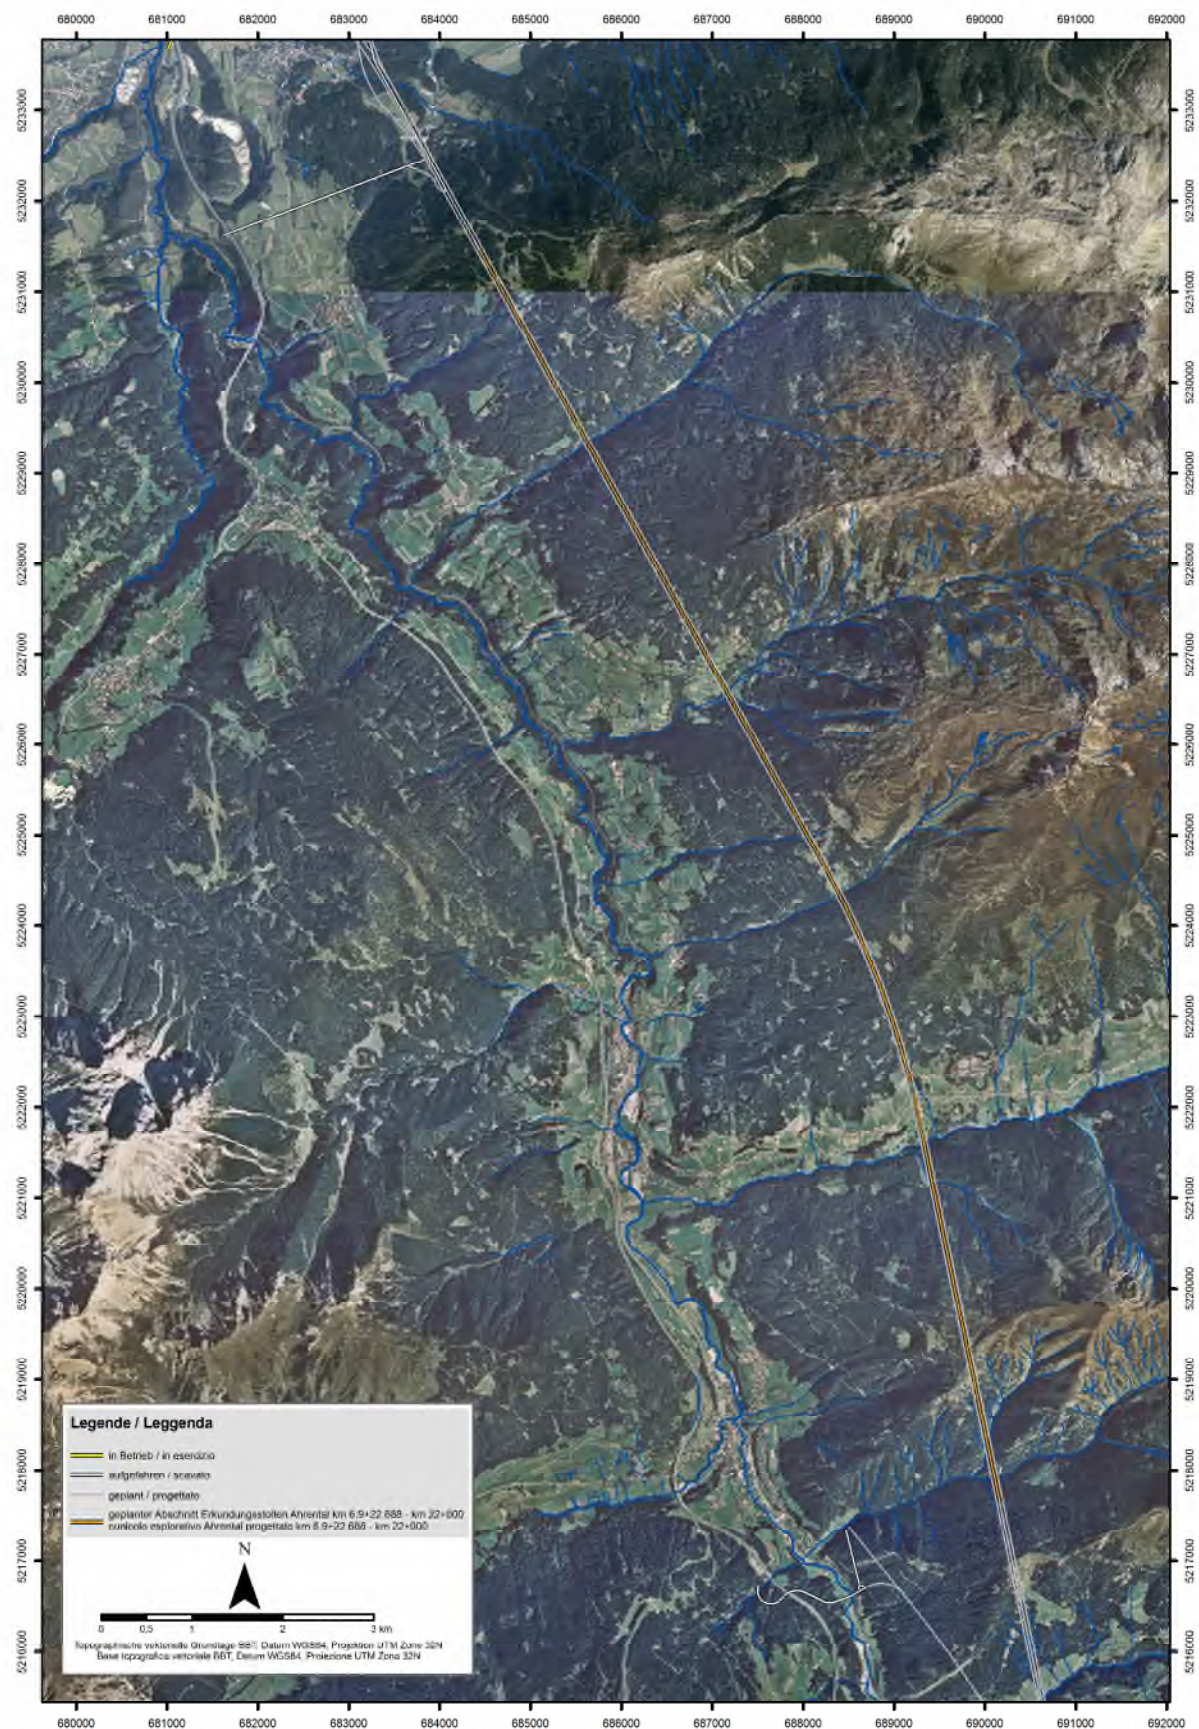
Übersicht über Projektgebiet mit bestehenden und geplanten Tunnelbauwerken, in braun der geplante Erkundungsstollen Ahrental
